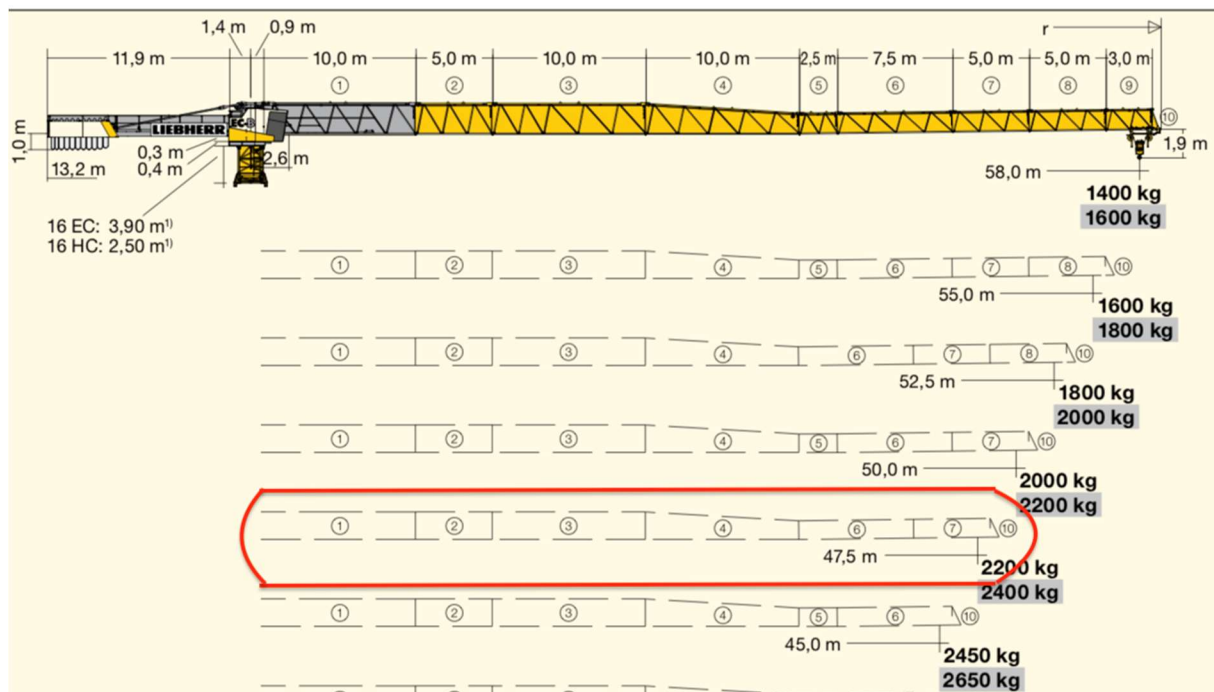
Technický list jeřábu Liebherr 12 EC 125 [12]
